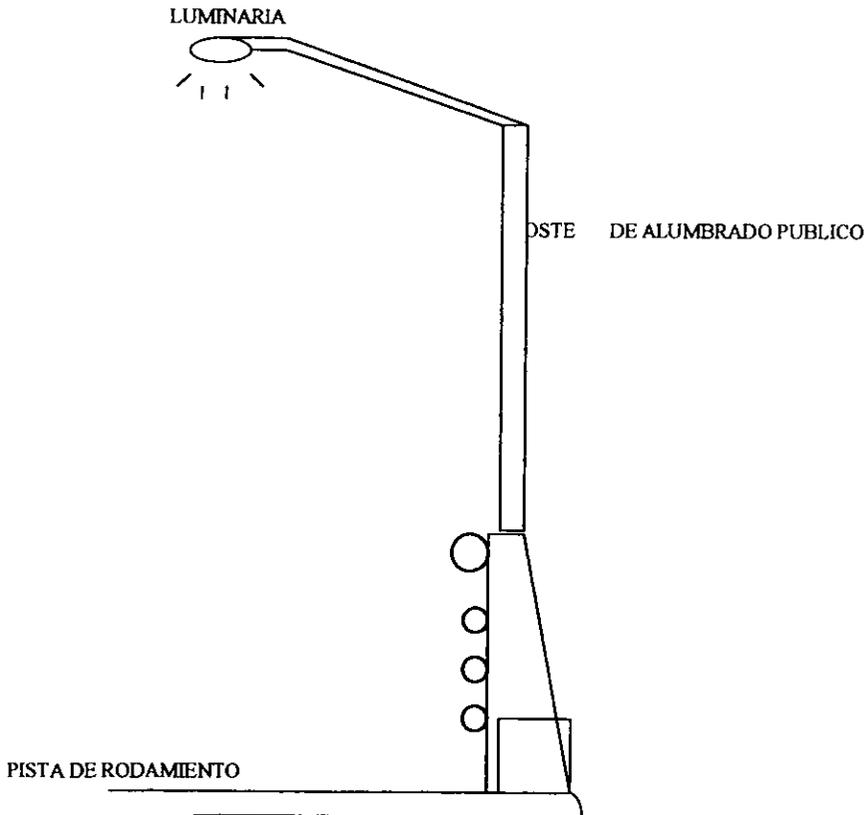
PARAPETO Y ALUMBRADO PUBLICO
